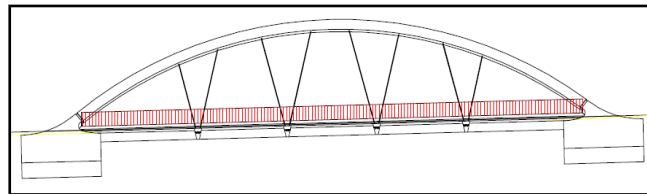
La charge type A sur toute la longueur du tablier (Position typique n°1 et 2)
